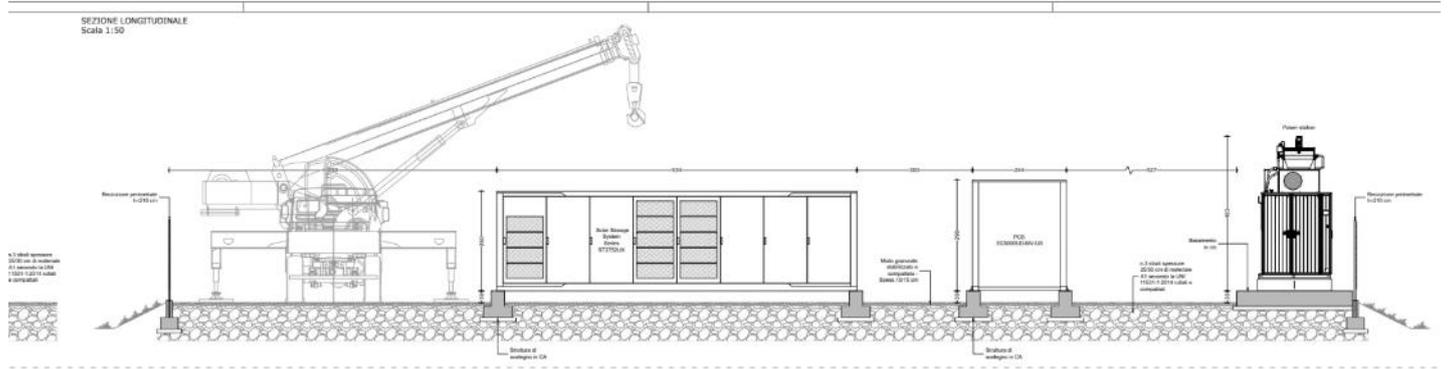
Sistema BESS: planimetria e sezione longitudinale (particolare)
